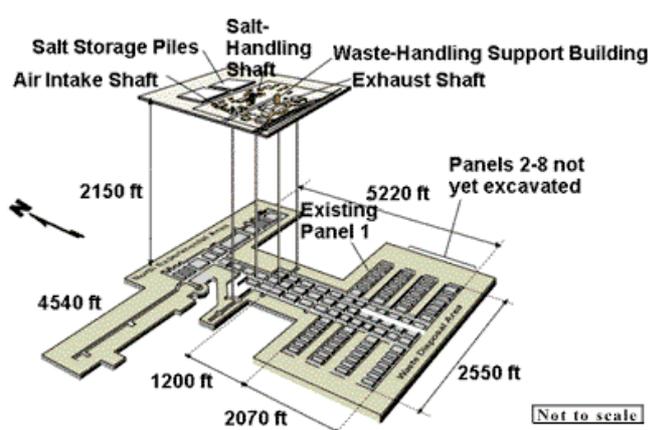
Waste Isolation Pilot Plant (USA, Carlsbad, New Mexico)
